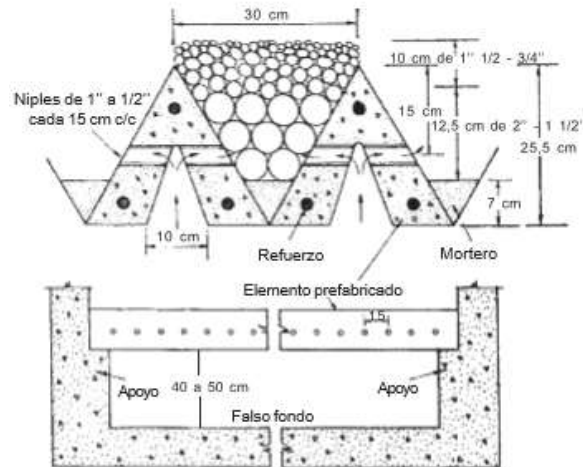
Drenaje de viguetas prefabricadas de concreto
